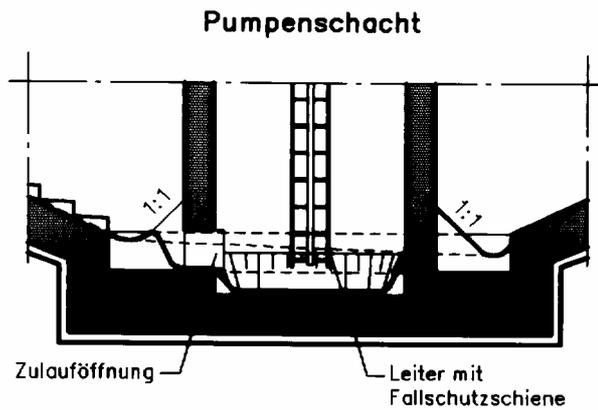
Beispiel für Detail Sohlausbildung im Bereich mittlerer Pumpenschacht
